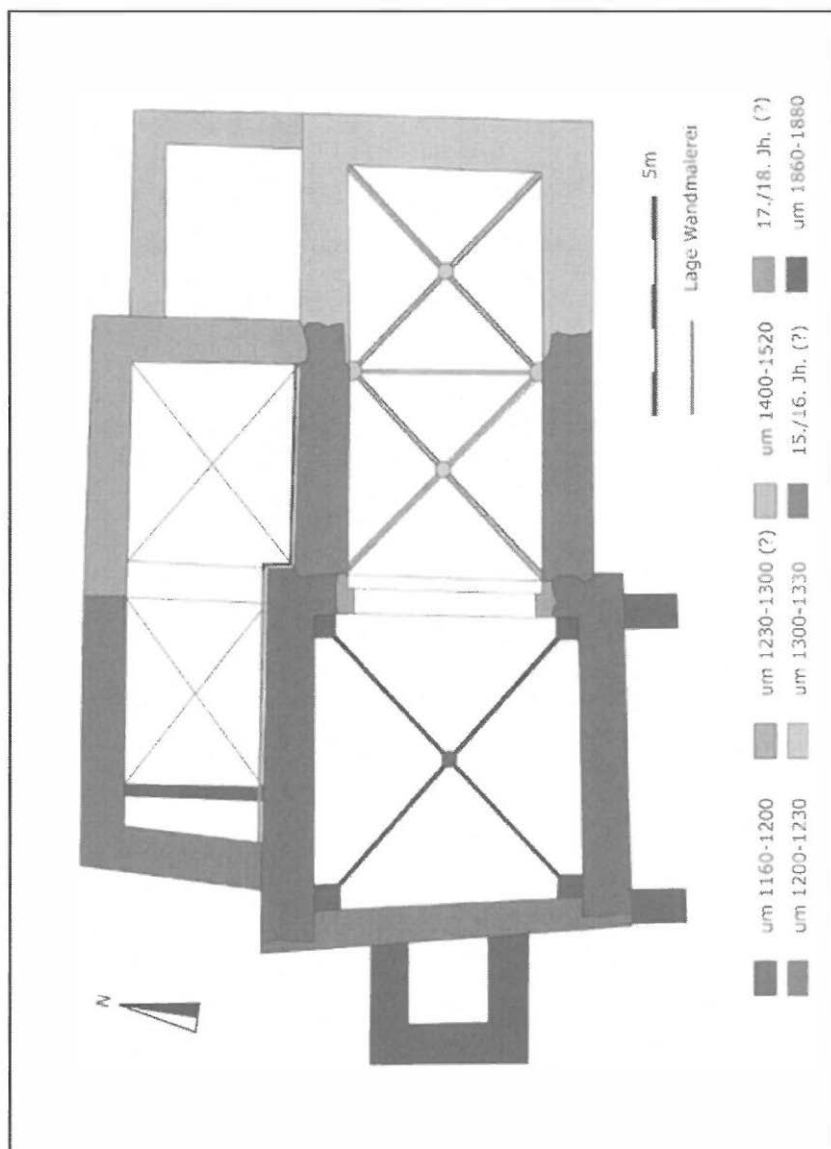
Winkl, St. Nikolaus: Baualtersplan
